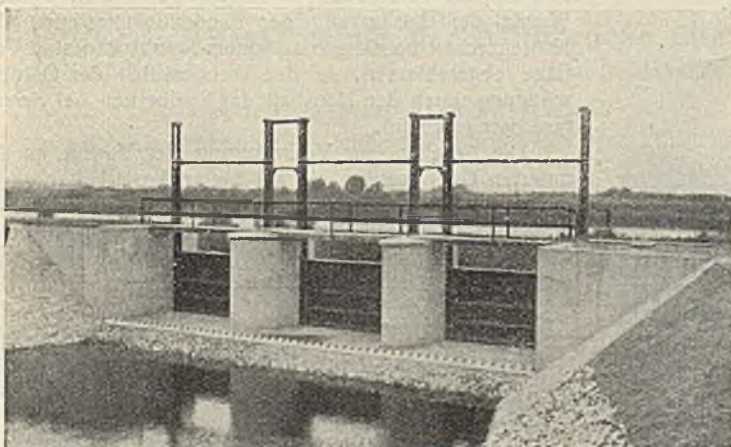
Untere Oder. Einlaßbauwerk am Dewingraben mit Zahnschwelle.
